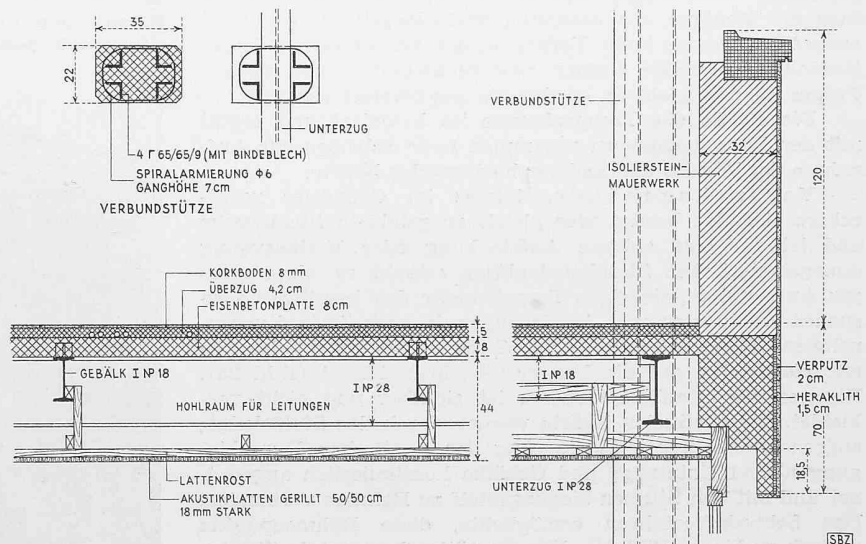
Laborgebäude; Ausbildung der Decken, Stützen und Fassaden, 1:30
